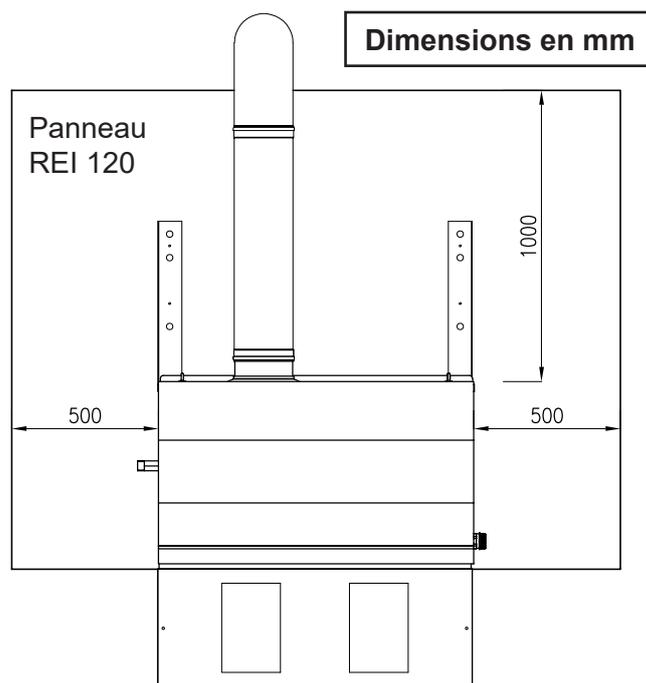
Vue arrière de l'unité Oha avec indication des dimensions du panneau REI 120
